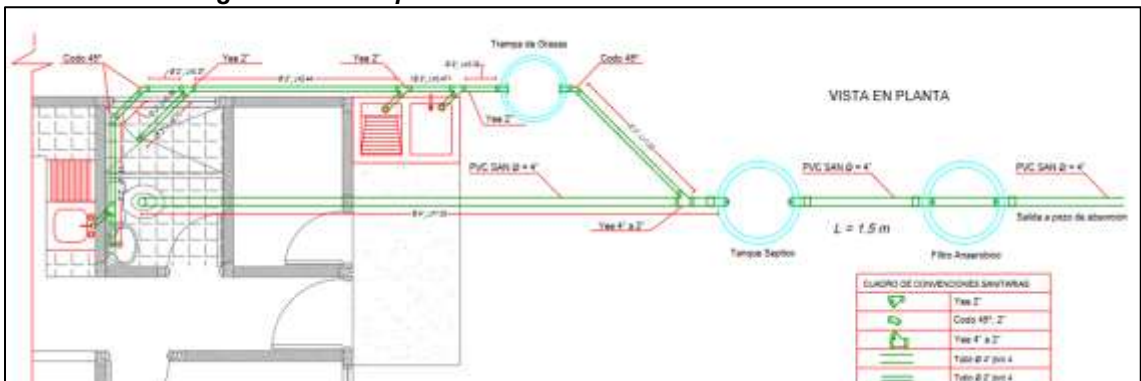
Plano tipo detalle conexiones hidráulicas vivienda nueva.
